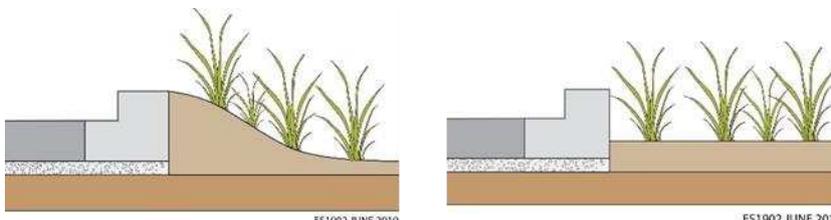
Lati inclinati e parete verticale della fioriera (viste in sezione). Fonte: Storm Water Management (SWMM)
